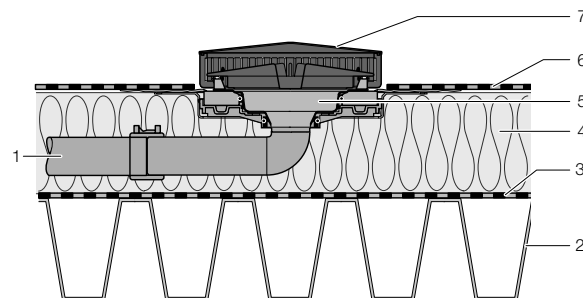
Конструкция легкой кровли, изолированной, горизонтальный излив в тепловой изоляции, с кровельным покрытием и пароизоляцией
